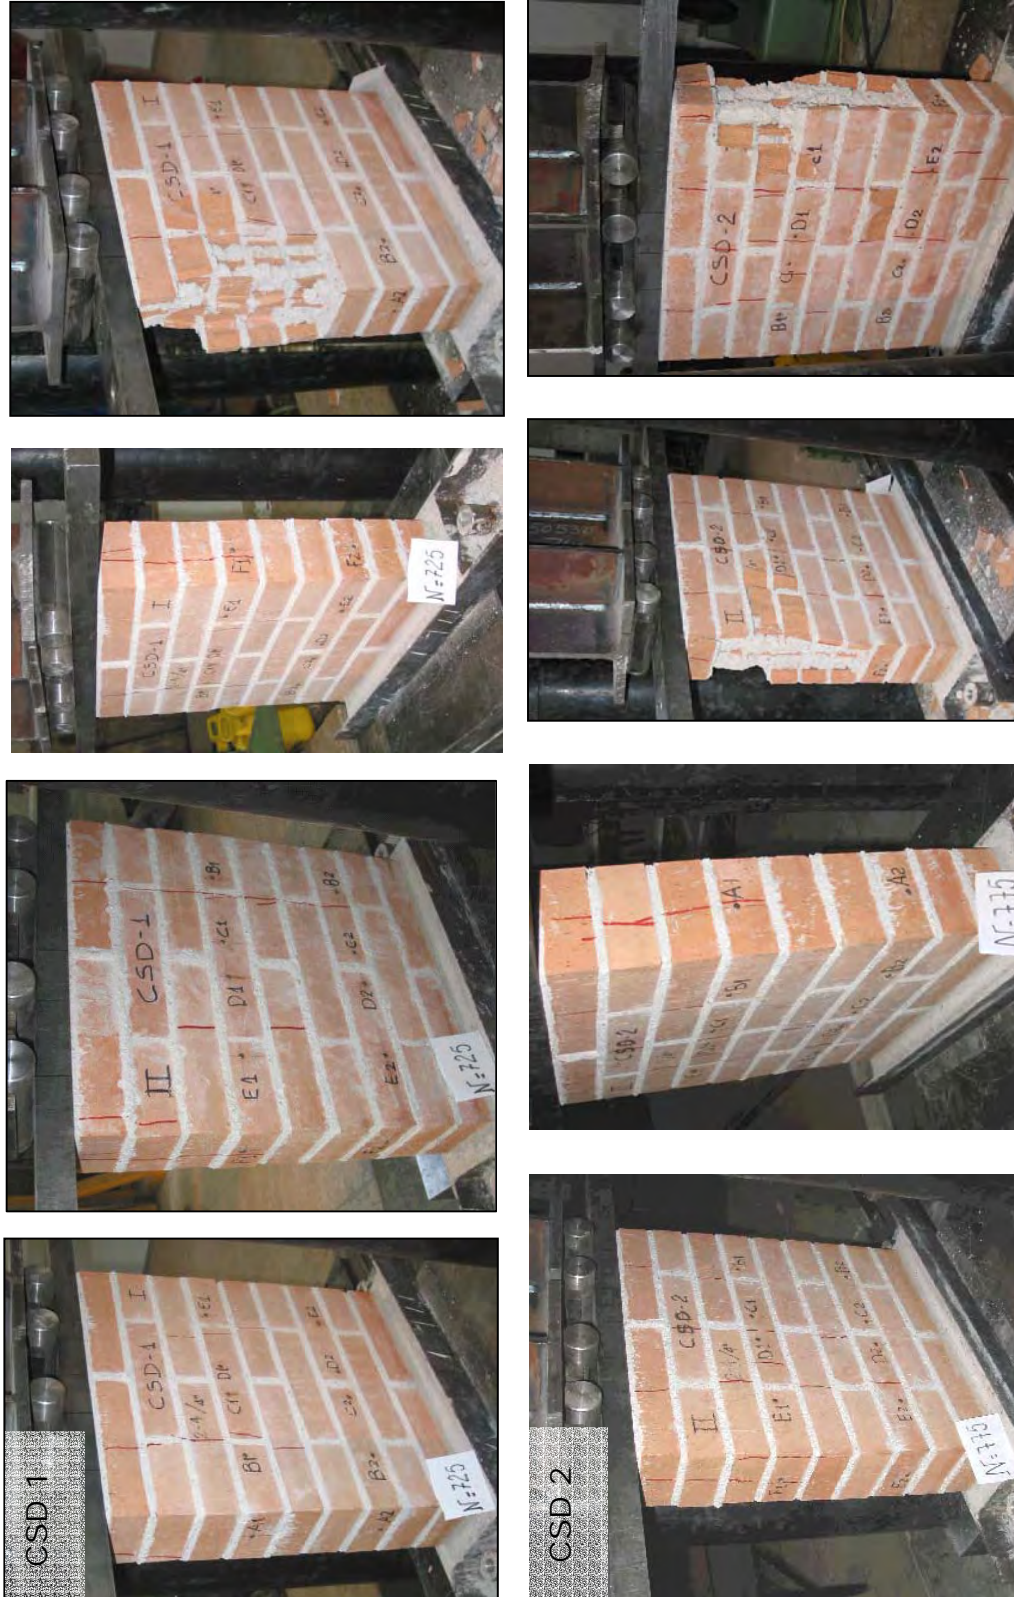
CSD1, fisuración en el último escalón de carga, la cara F parece más dañada que la A, sin embargo el fallo se desencadena finalmente por separación de la pared en las testas del lado A. CSD2, daño generalizado en el último escalón de carga y aspecto del fallo.
